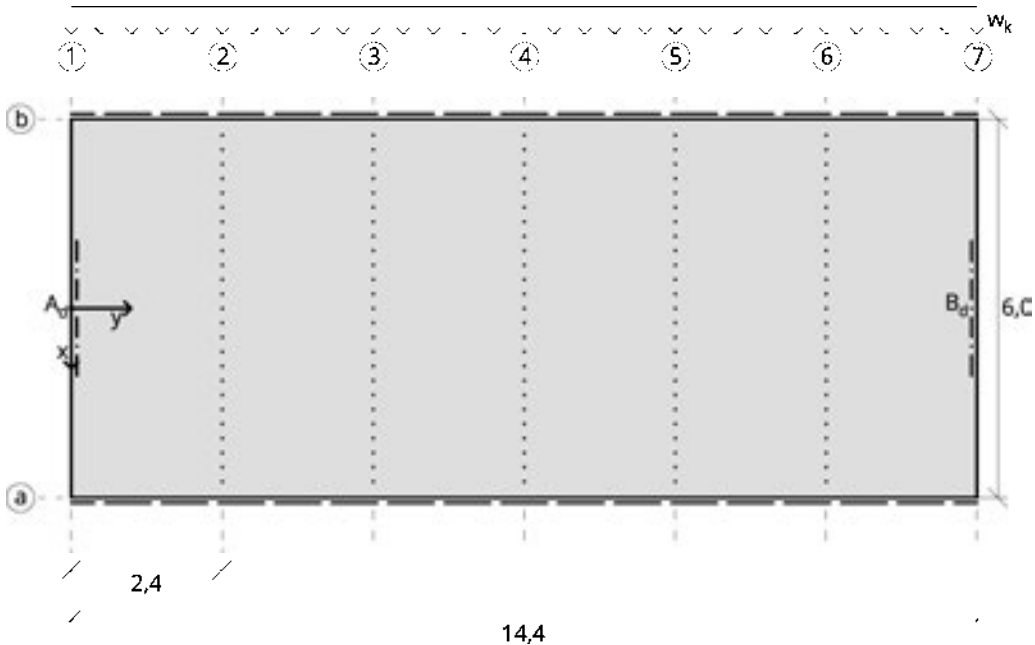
Grundriss der Deckenscheibe
